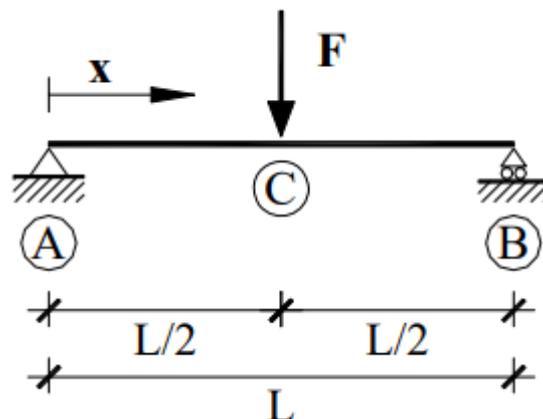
Esquemas inicial de cargas de viga IPN. (Bañón, 2009)
